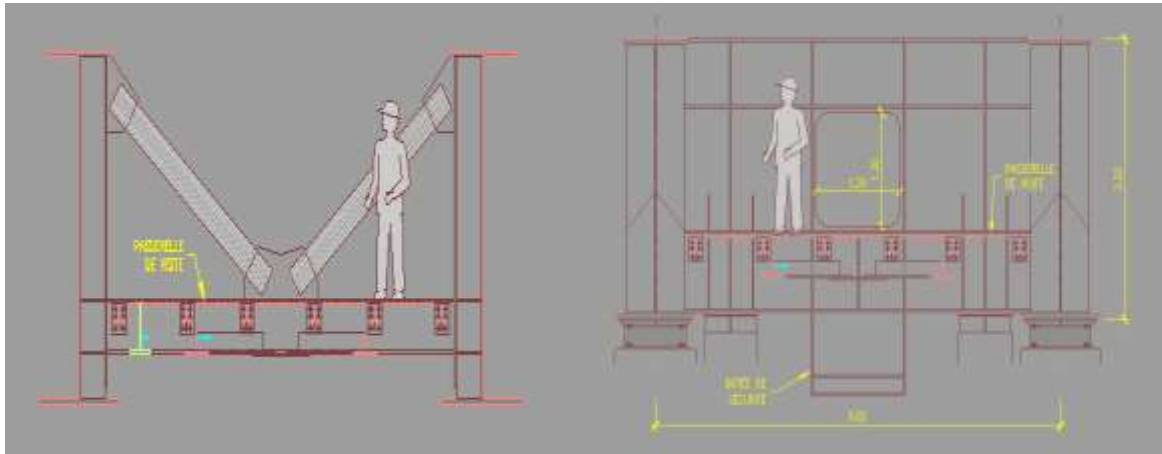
Photo de Voussoirs (appui+ travée) P3
